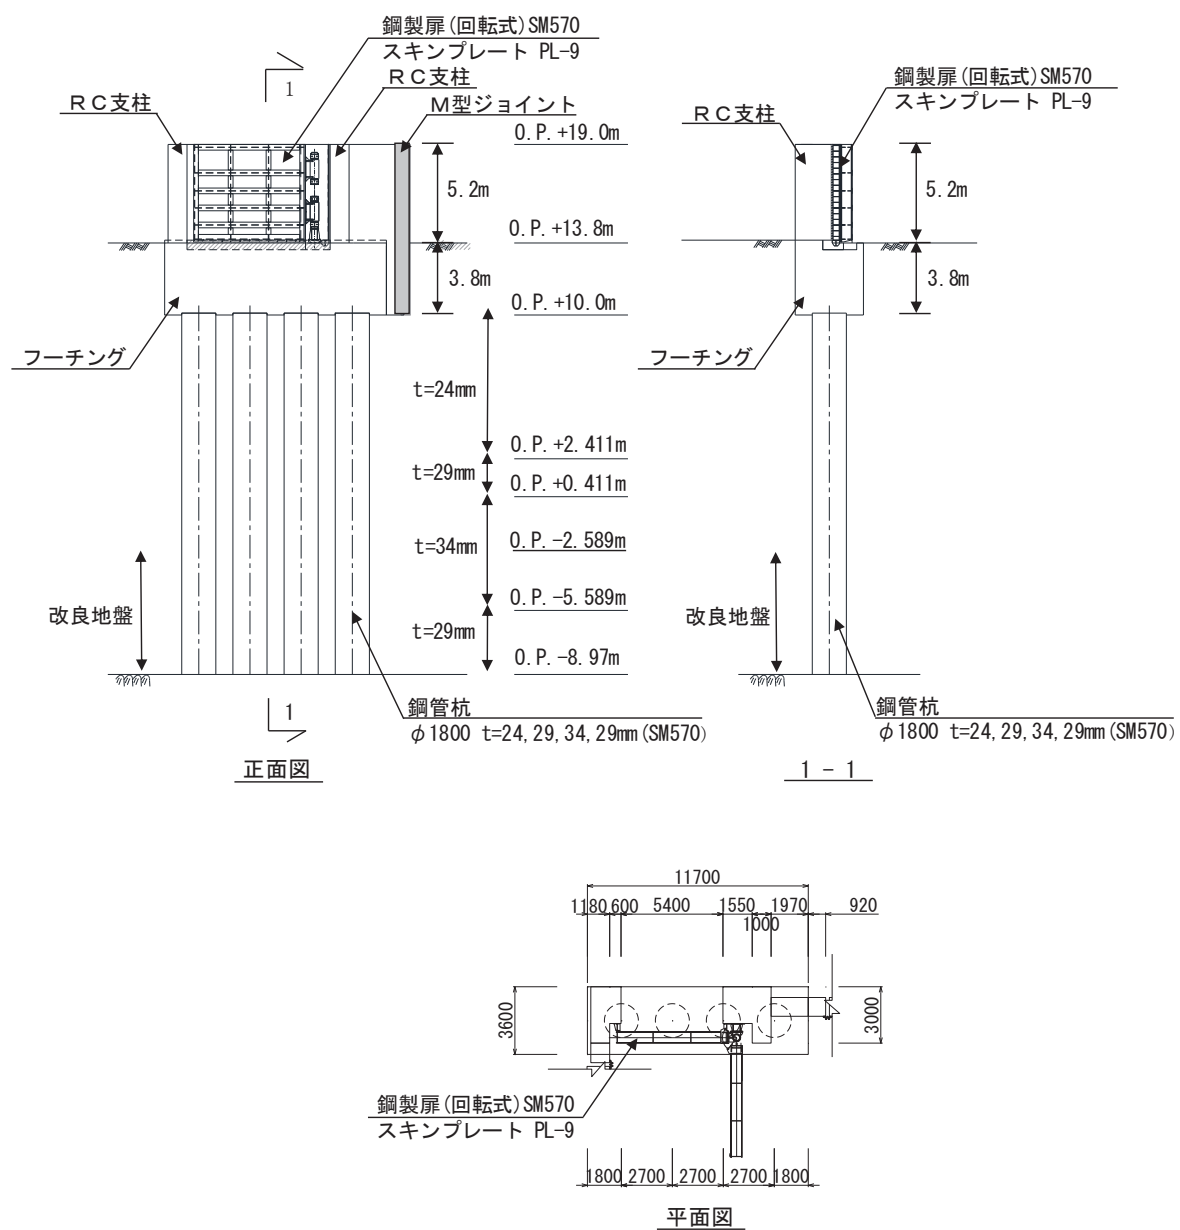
(1) 鋼製扉 1 の構造図 (正面図及び断面図, 平面図)
